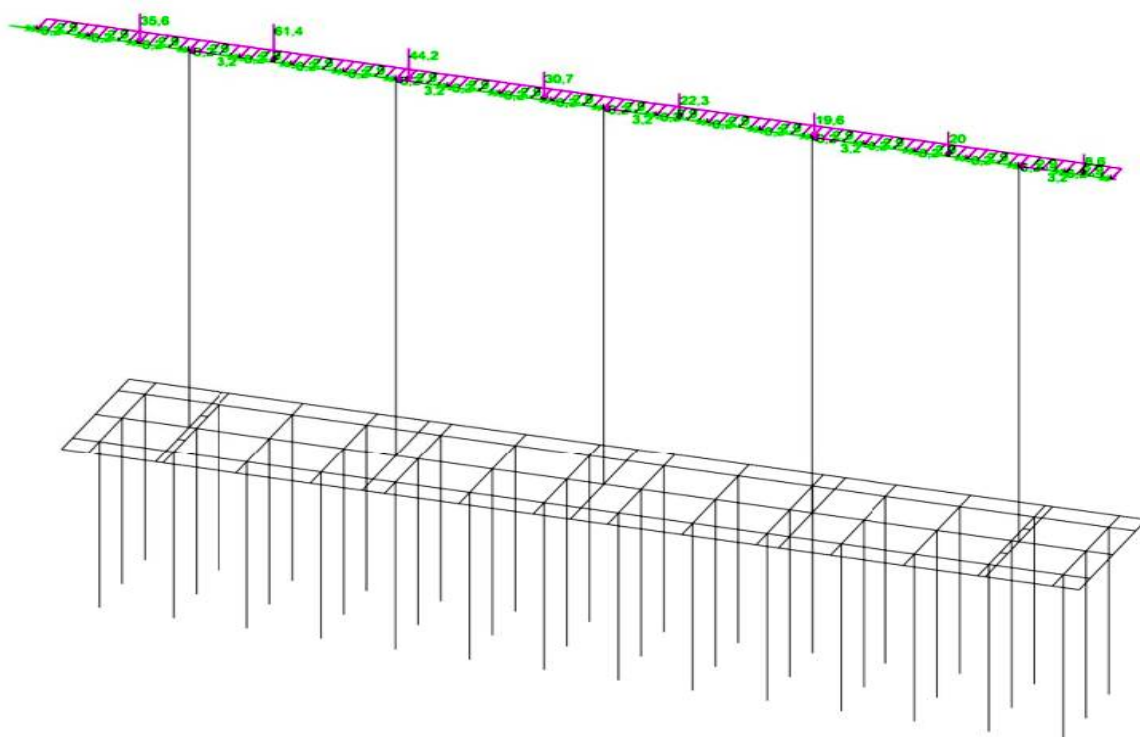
Расчетная схема для временной подвижной нагрузки А14
